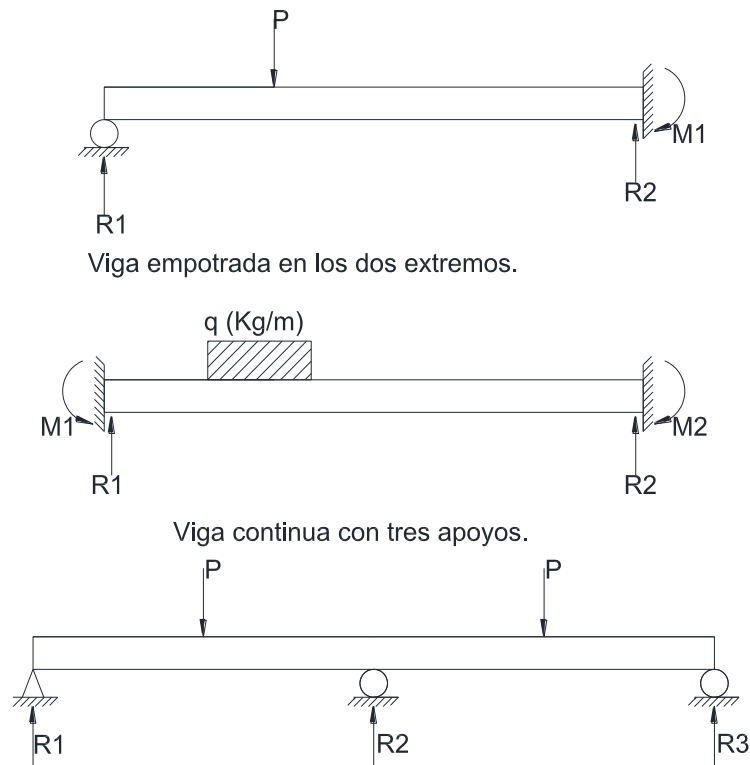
Tipos de vigas estáticamente indeterminadas.
